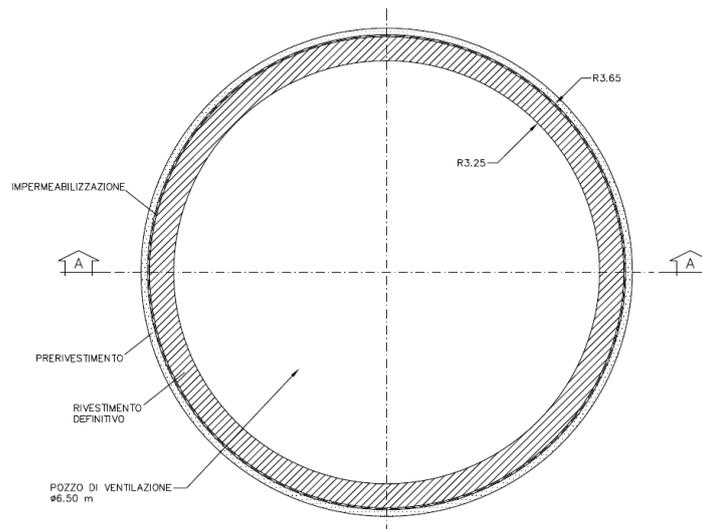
Particolare pianta del pozzo di ventilazione Val Lemme 1/2.
